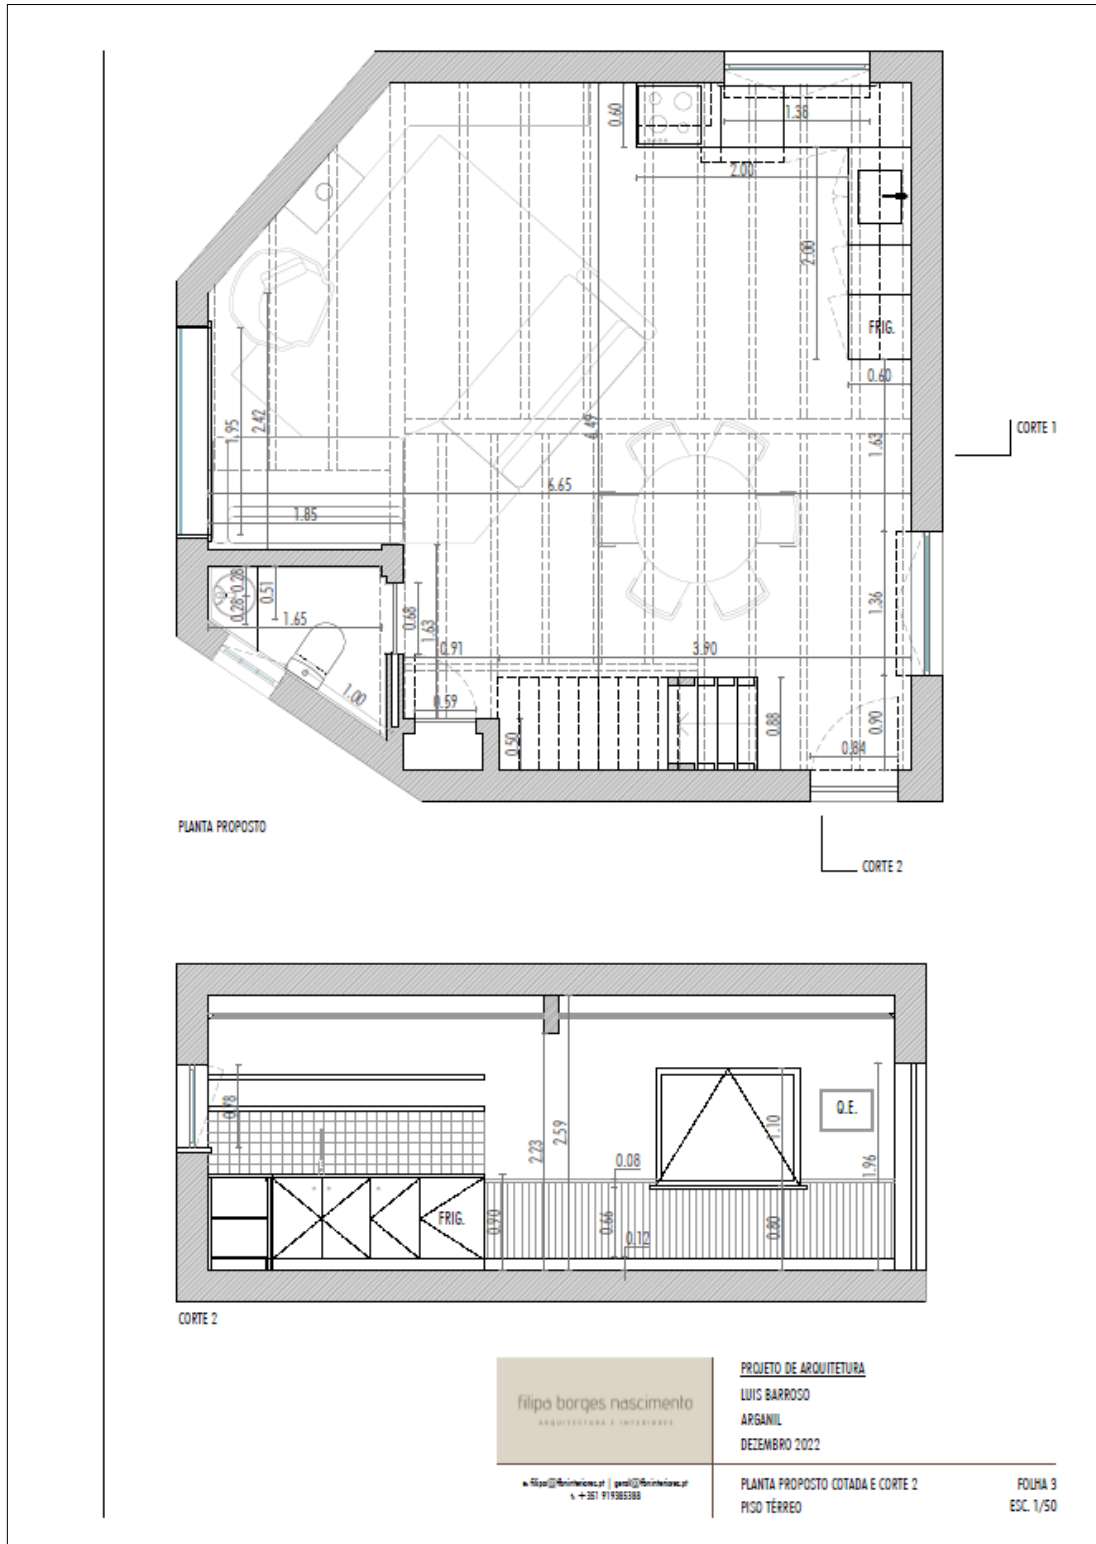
Planta proposta cotada e corte 2 (Fonte: Ana Soares, 2022)
